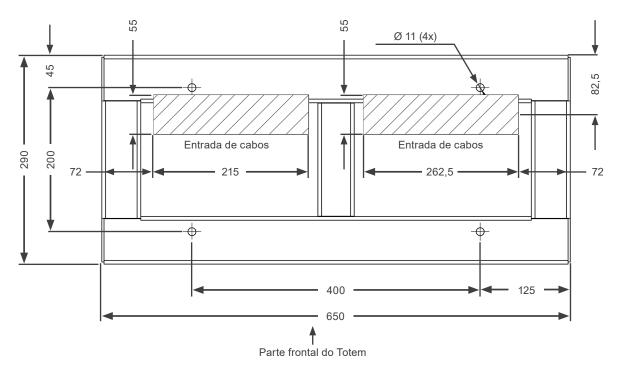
Dimensões para fixação e passagem dos eletrodutos do Totem – mm
